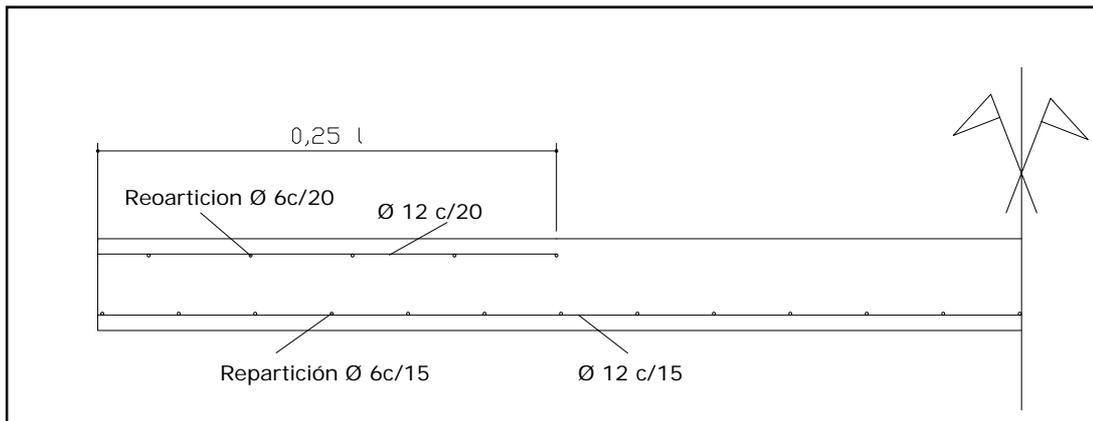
Esquema de armado de la losa de tribuna n° 4 en P.B.
